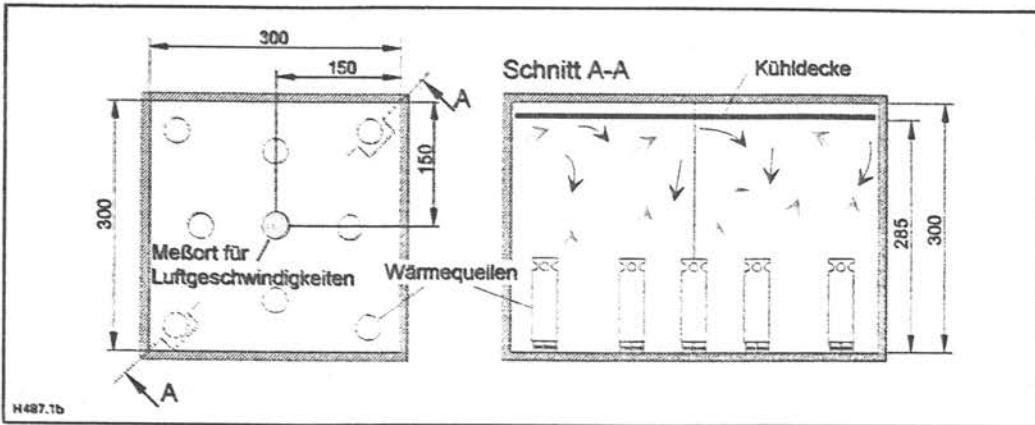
Grundriß und Querschnitt des Versuchsaufbaus mit gleichmäßig verteilten Wärmequellen (Maße in cm).
